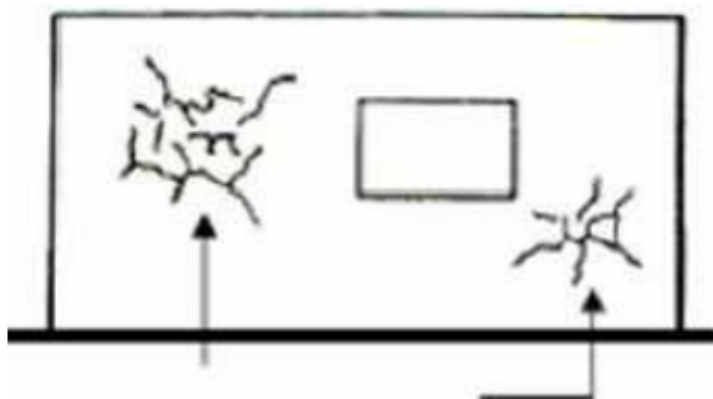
Fissuras em paredes devido à retração da alvenaria
